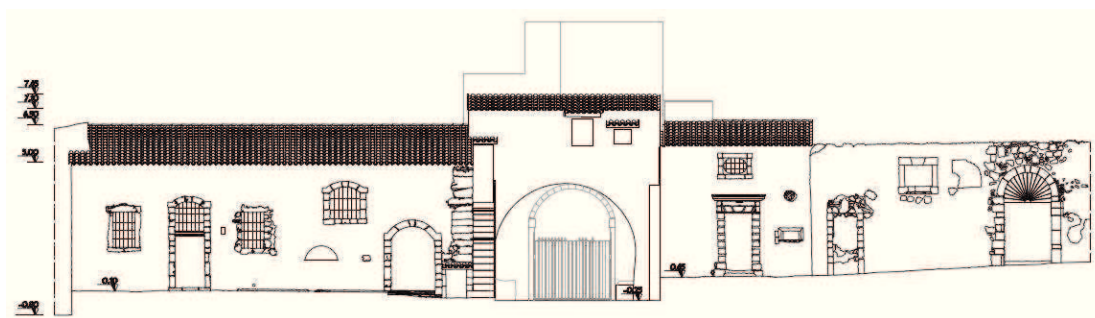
San Lorenzo Vecchio. Restituzione finale del prospetto interno alla corte, lato ovest, ricavata dall'integrazione di foto raddrizzamento e ortofoto 3D (restituzioni di Fabrizio Ragonese).
